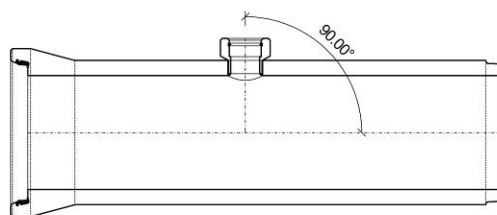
Anschlusswinkel CENTUB® Klebeanschlussstück 90°
